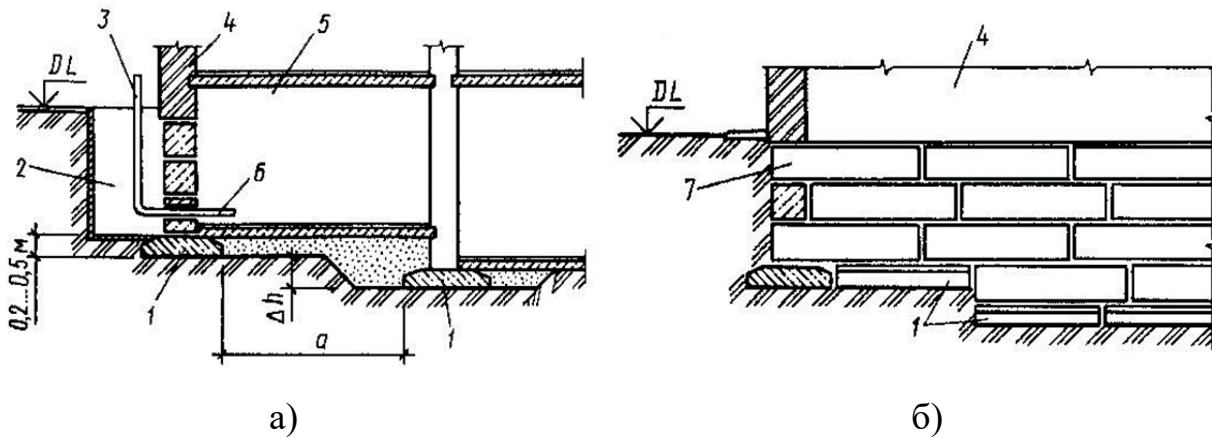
Вибір глибини закладання фундаменту залежно від конструктивних особливостей споруди: а – будівля з підвалом в різних рівнях і відсіком; б – зміна глибини закладання стрічкового фундаменту; 1 – фундаментні плити; 2 – відсік; 3 – трубопровід; 4 – стіна будівлі; 5 – підвал; 6 – введення трубопроводу; 7 – стінні блоки
